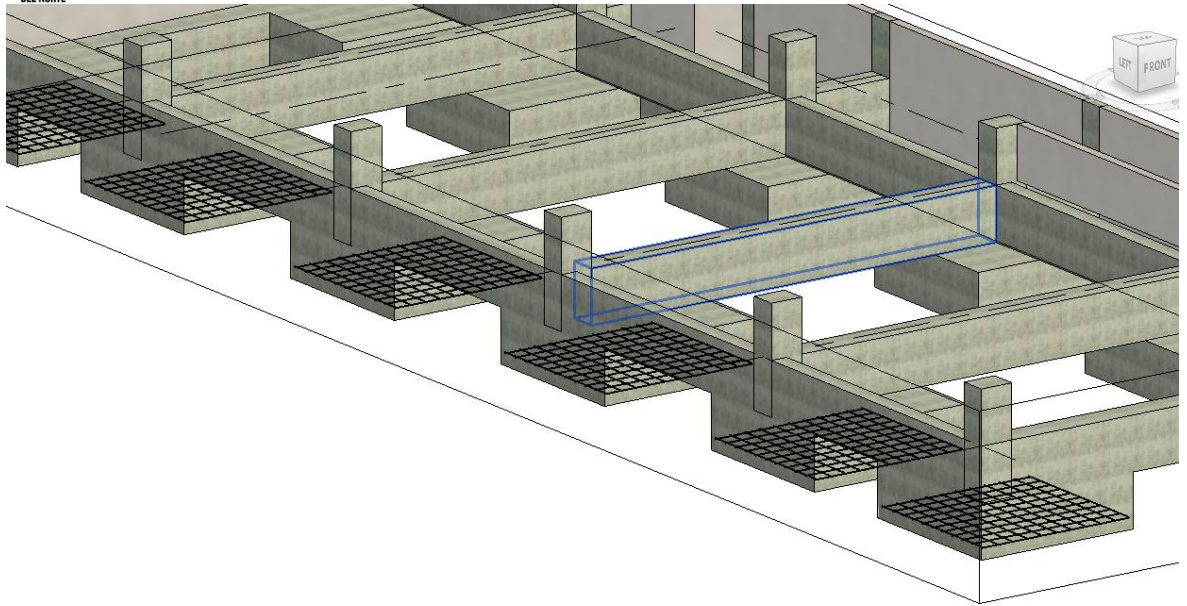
Vista 3D, se observa el detalle del enmallado de acero en Zapatas (Fuente: Elaboración Propia).
